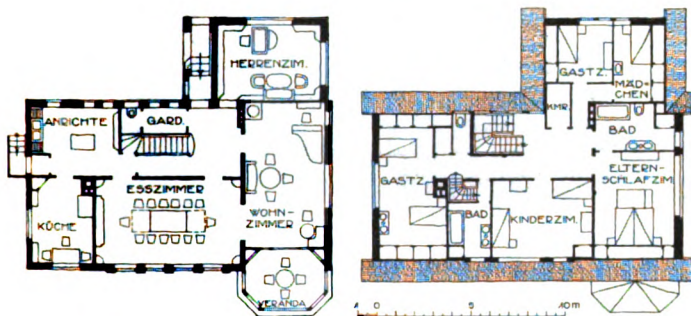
u. 13. Haus Plesch bei Hamburg. Grundrisse 1:400.
